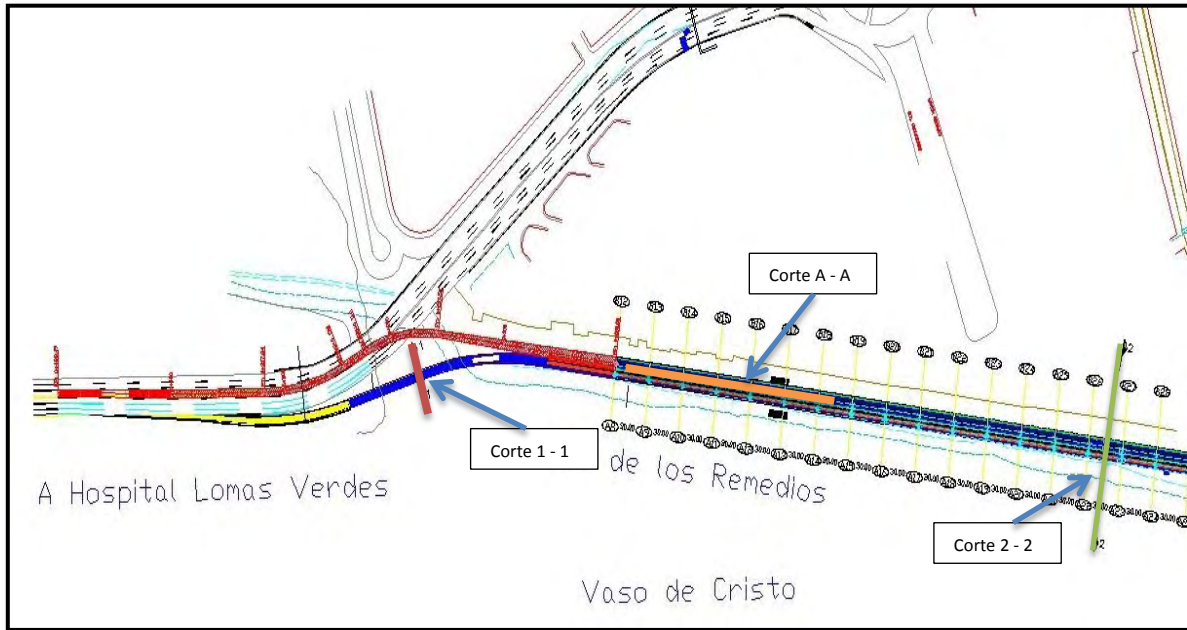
En la siguiente imagen se observan los cortes longitudinales y transversales realizados sobre la planta de trabajo en la cual tendremos, los diferentes tipos y anchos de columnas y traveses, así como las zapatas sobre las cuales se montaran o se colaran en sitio las columnas. Así mismo vemos los cortes 1-1, 2-2 y el corte A-A y que más adelante se detallaran.
